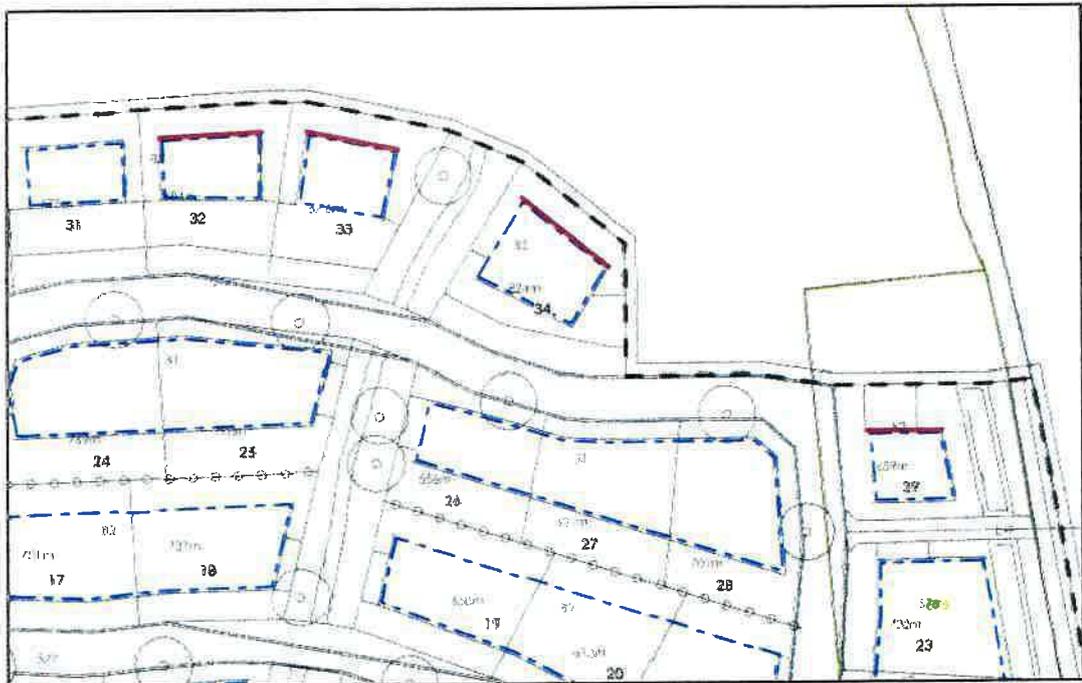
Lageplan mit Kennzeichnung (rot) der relevanten Baugrenzen
